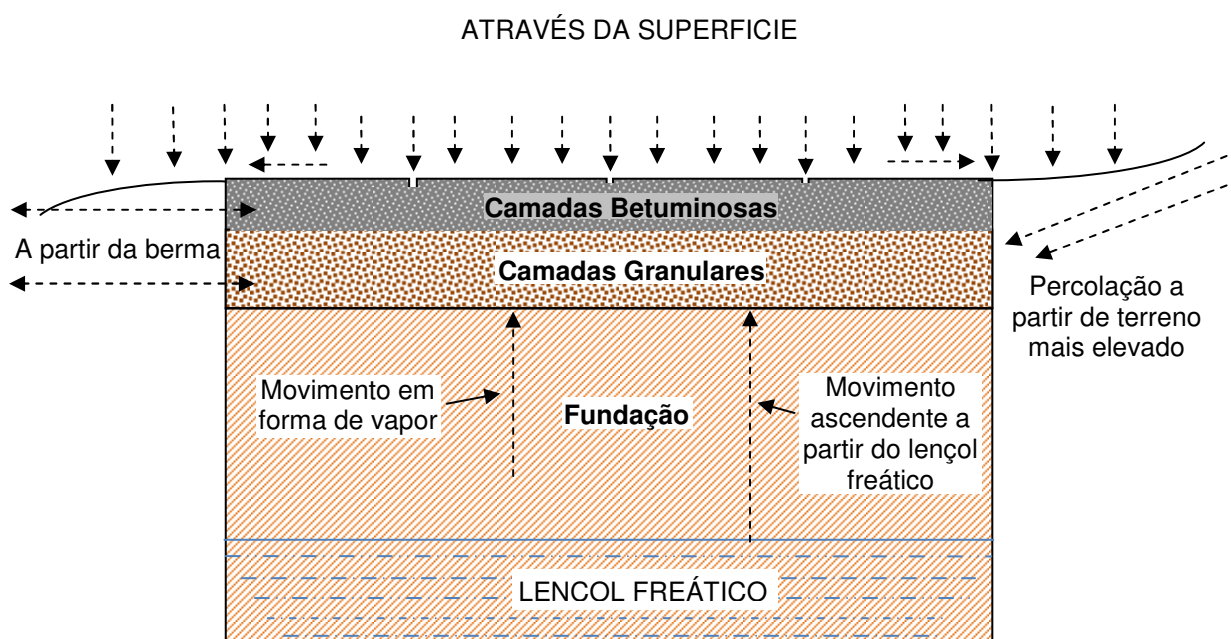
A presença da água num pavimento (adaptado de Miranda, 2008)
